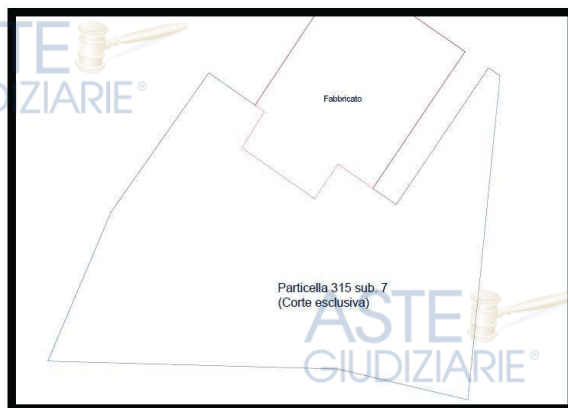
PLANIMETRIA CORTE REDATTA DAL CTU - IN ALLEGATO
